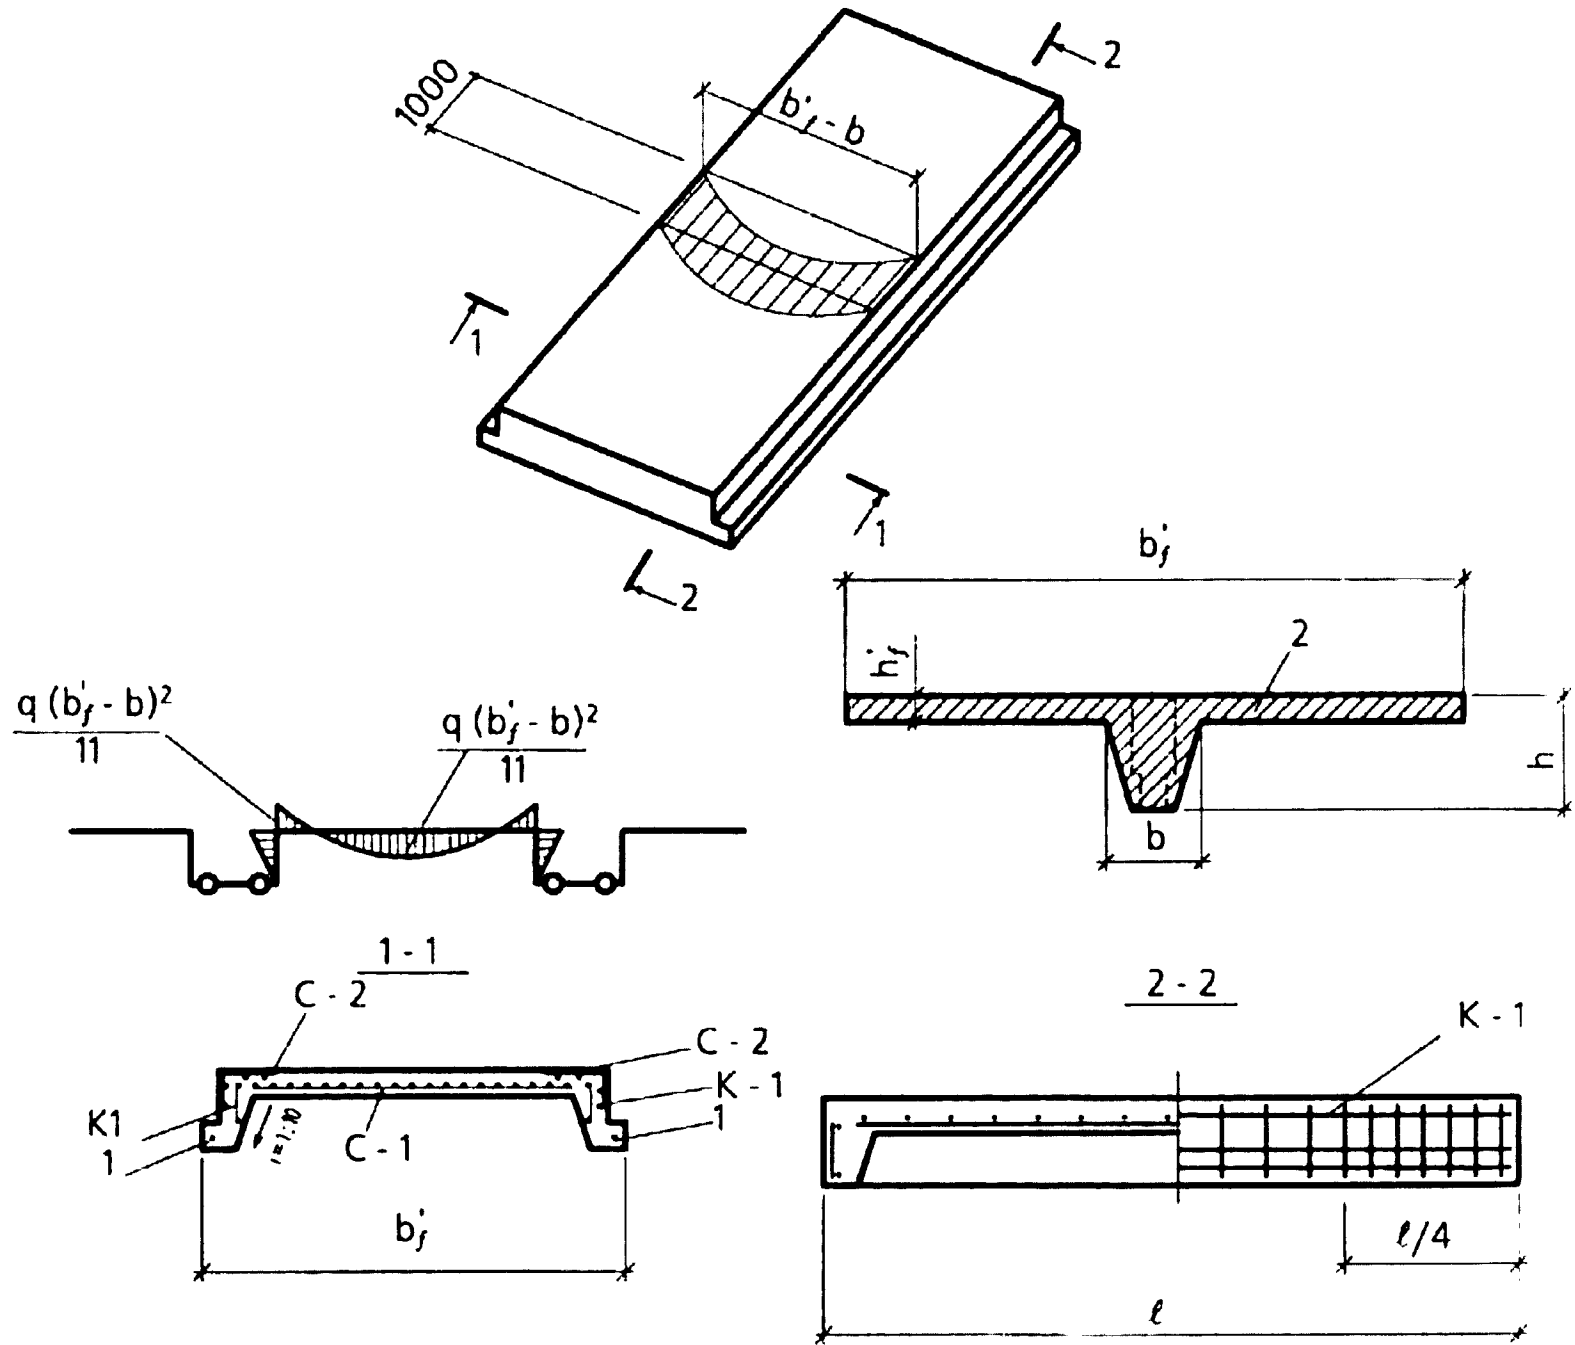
Конструкция сборной ребристой панели перекрытия:
